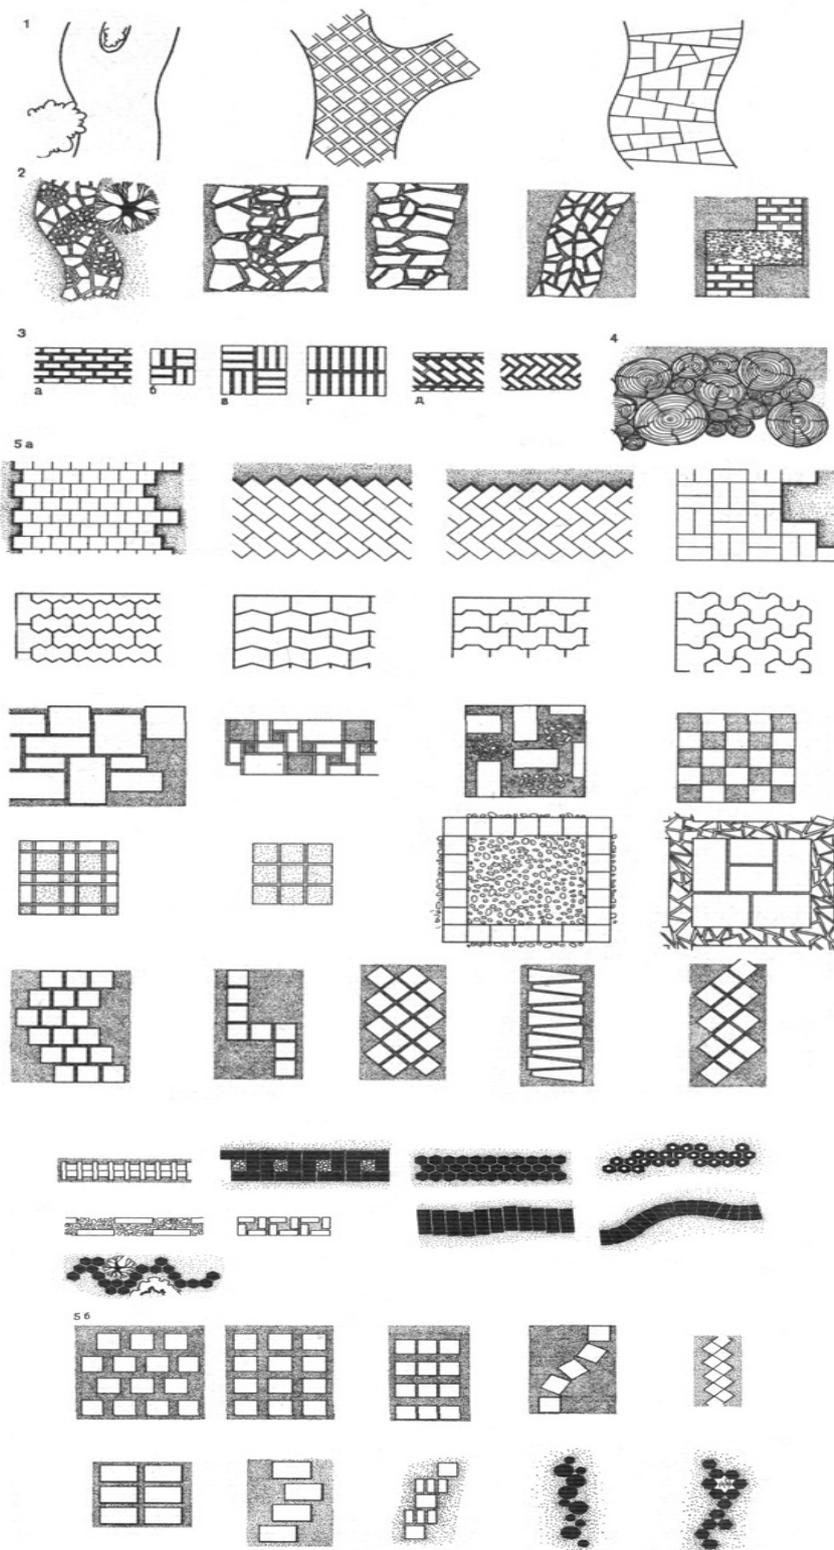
Покрытия: 1 – монолитные бетонные; 2 – из натурального камня; 3 – кирпичные (а, б – вперевязку; в – плетенка; г – сетка; е – елочка); 4 – из дерева; 5 – из бетонных плит (а – без разрыва; б – с разрывом)
